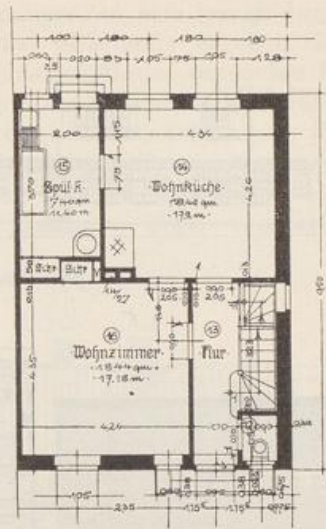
Grundriß zu Abb. 80. Erdgeschoß, rechte Hälfte.
